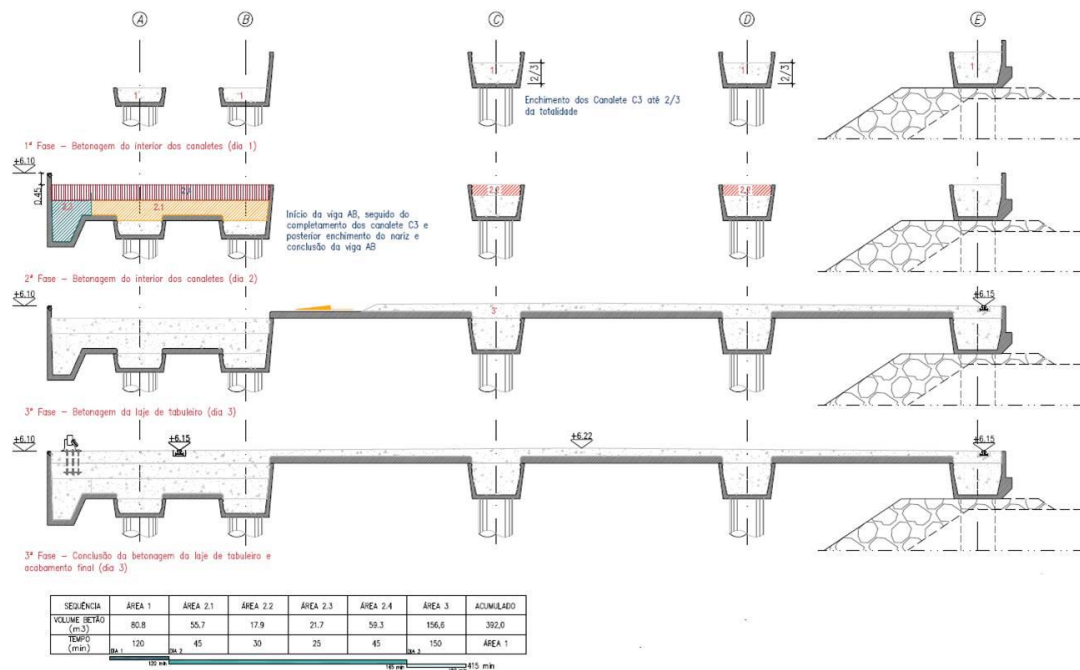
betonagem do tabuleiro: Plano transversal de betonagem
